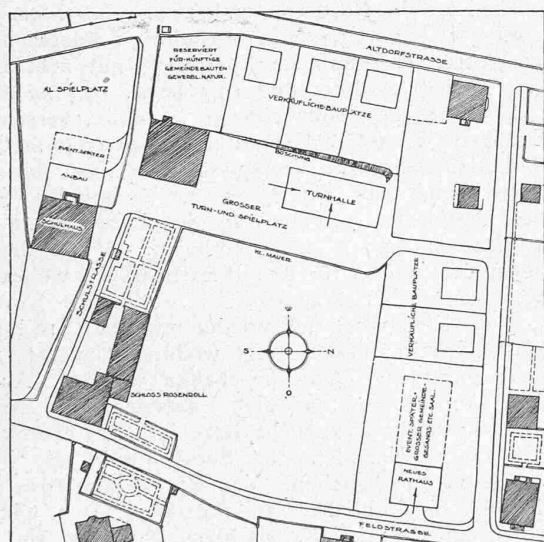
Lageplan des Schulhauses mit neuer Turnhalle. — 1:2000.
